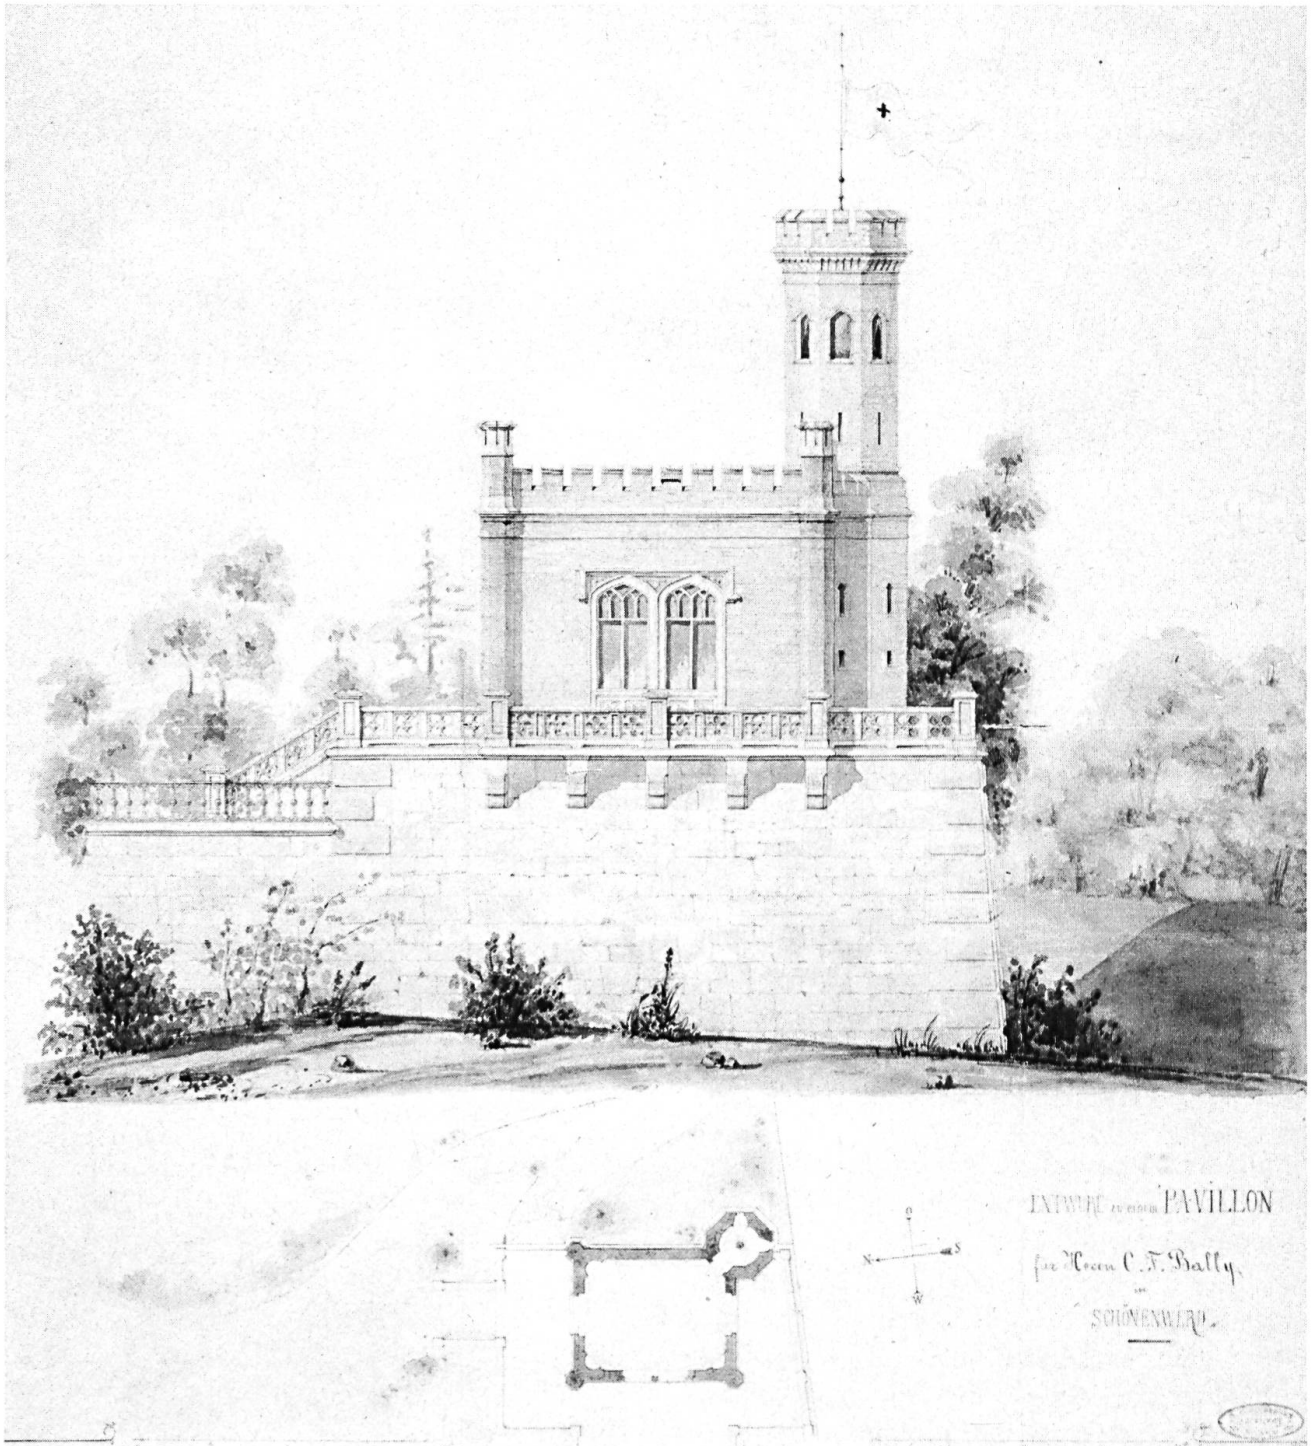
Schönenwerd, Schlösschen im Park des «Felsengartens». Reich kolorierter Entwurfsplan von Jakob Gottfried Octavian Schönberger mit Ansicht von Norden samt Grundriss. Bereits in diesem (geringfügig verändert ausgeführten) Plan ist der grosse Stellenwert erkennbar, der etwa Details wie den Masswerk-Steinhauerarbeiten an den Brüstungen und Fensterrahmen zugewiesen wird. (Baubüro Bally, Schönenwerd).
